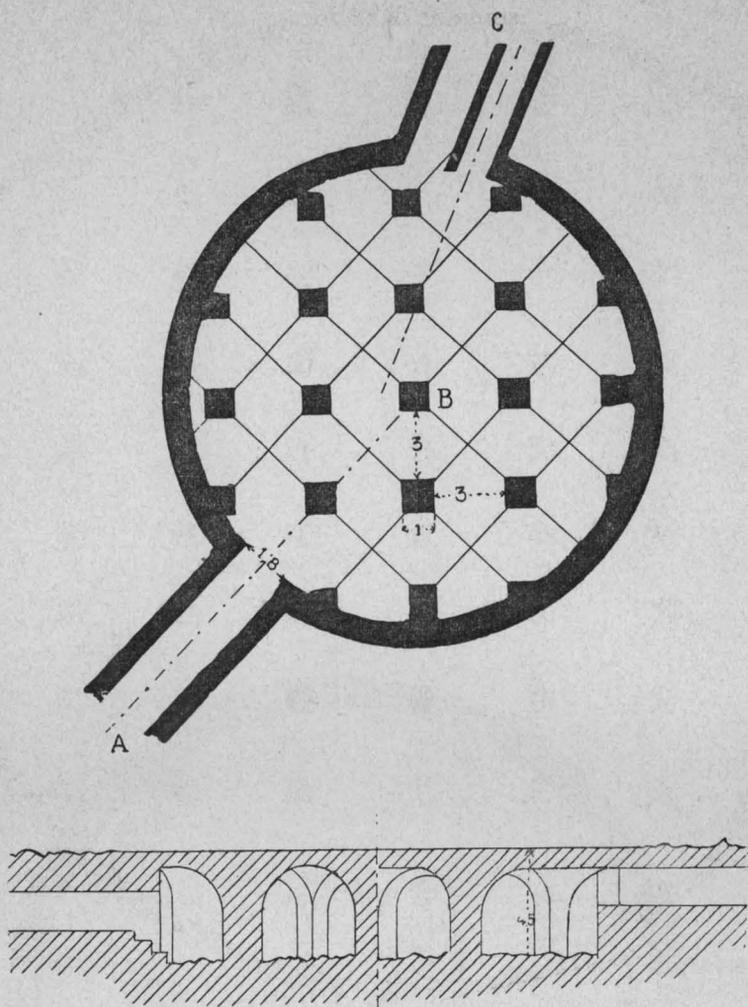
et 24. — PETIT RÉSERVOIR DE ROUGGA. Plan et coupe.
